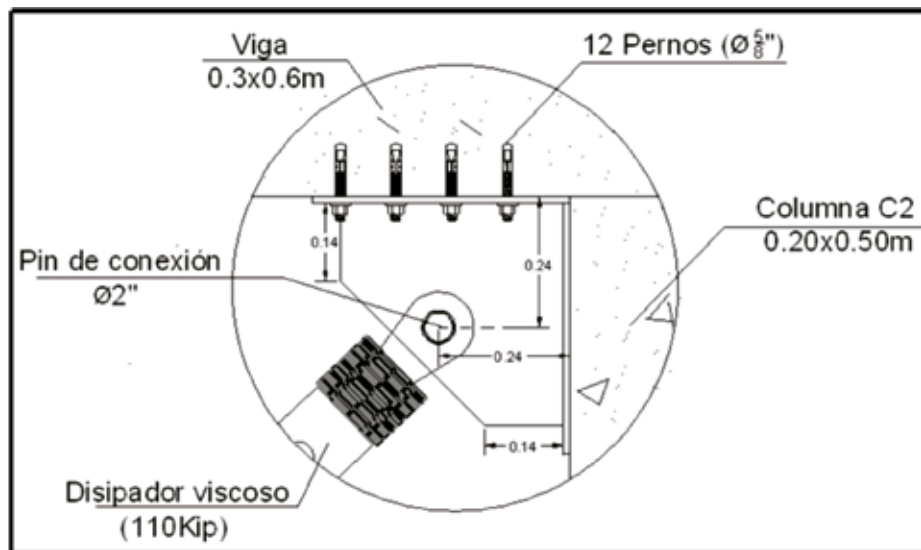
DETALLE 2 (CONEXIÓN: DISIPADOR – CARTELA – ESTRUCTURA DE CONCRETO)
